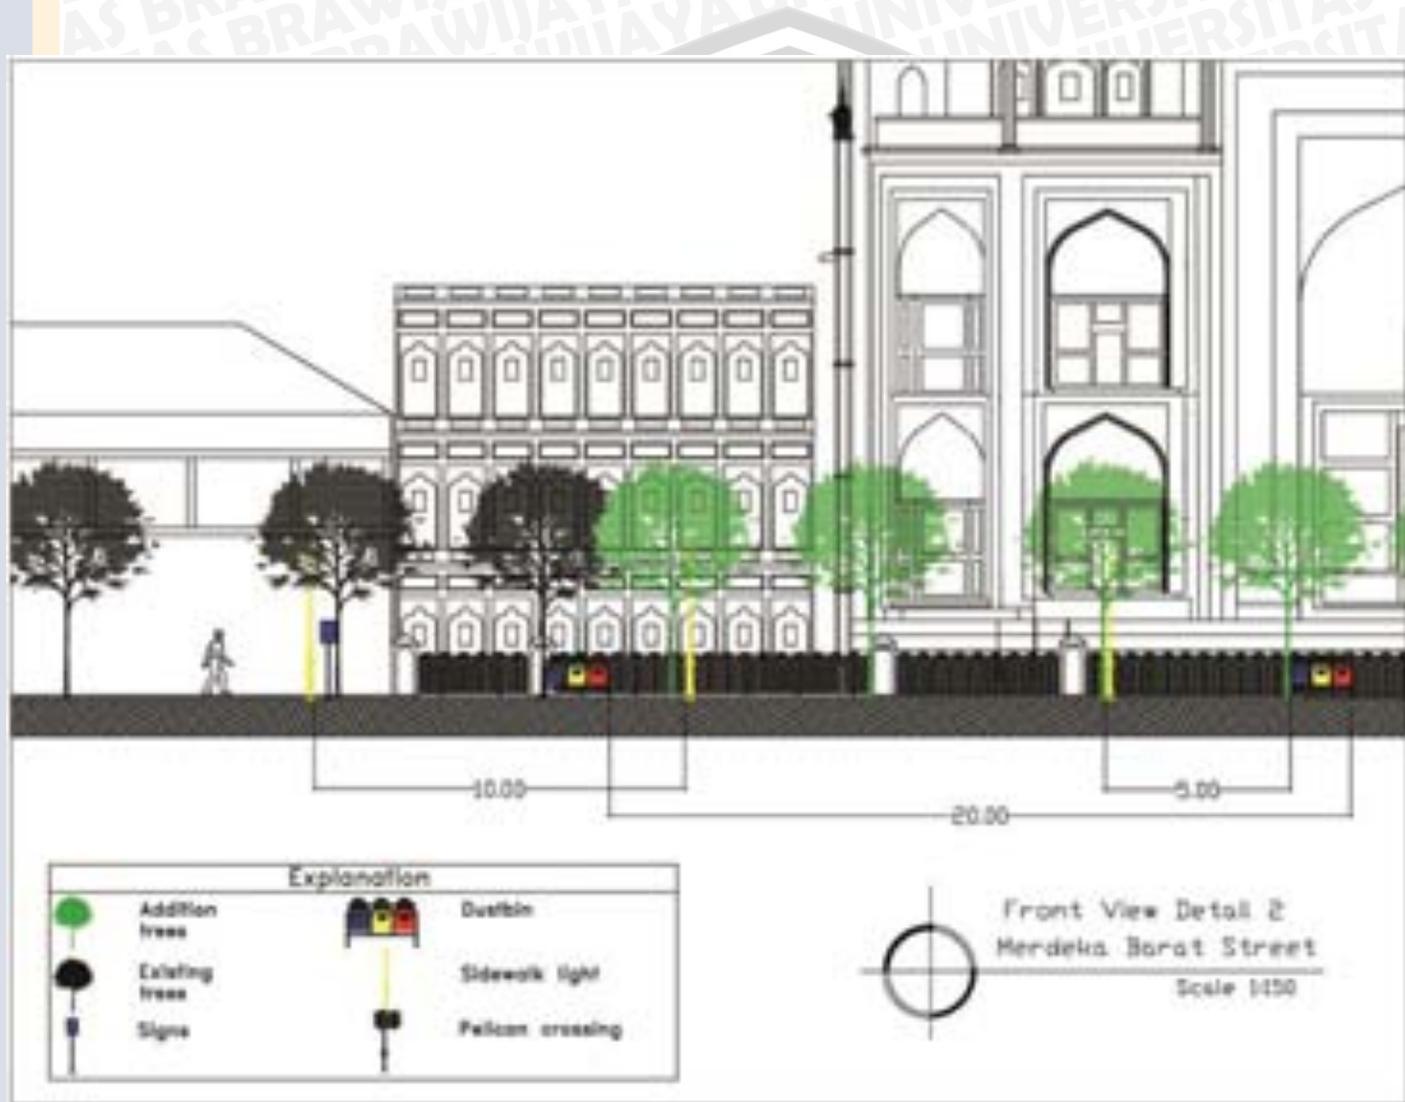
68 Detail Potongan Jalan Merdeka Barat
